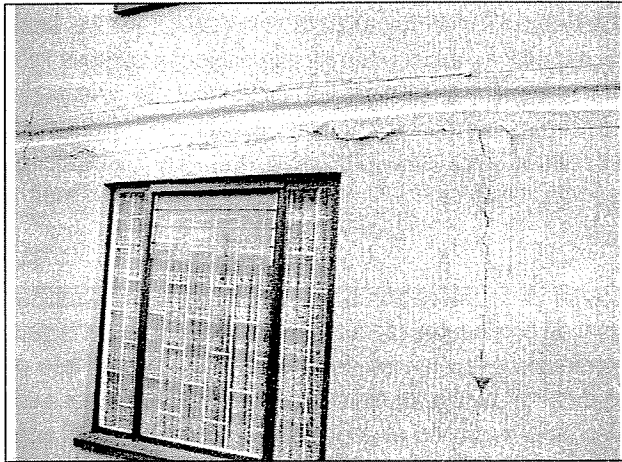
Grietas de dilatación entre muros, y entre muros y losa de entepiso en el costado noroccidental del bloque U, primer nivel.
